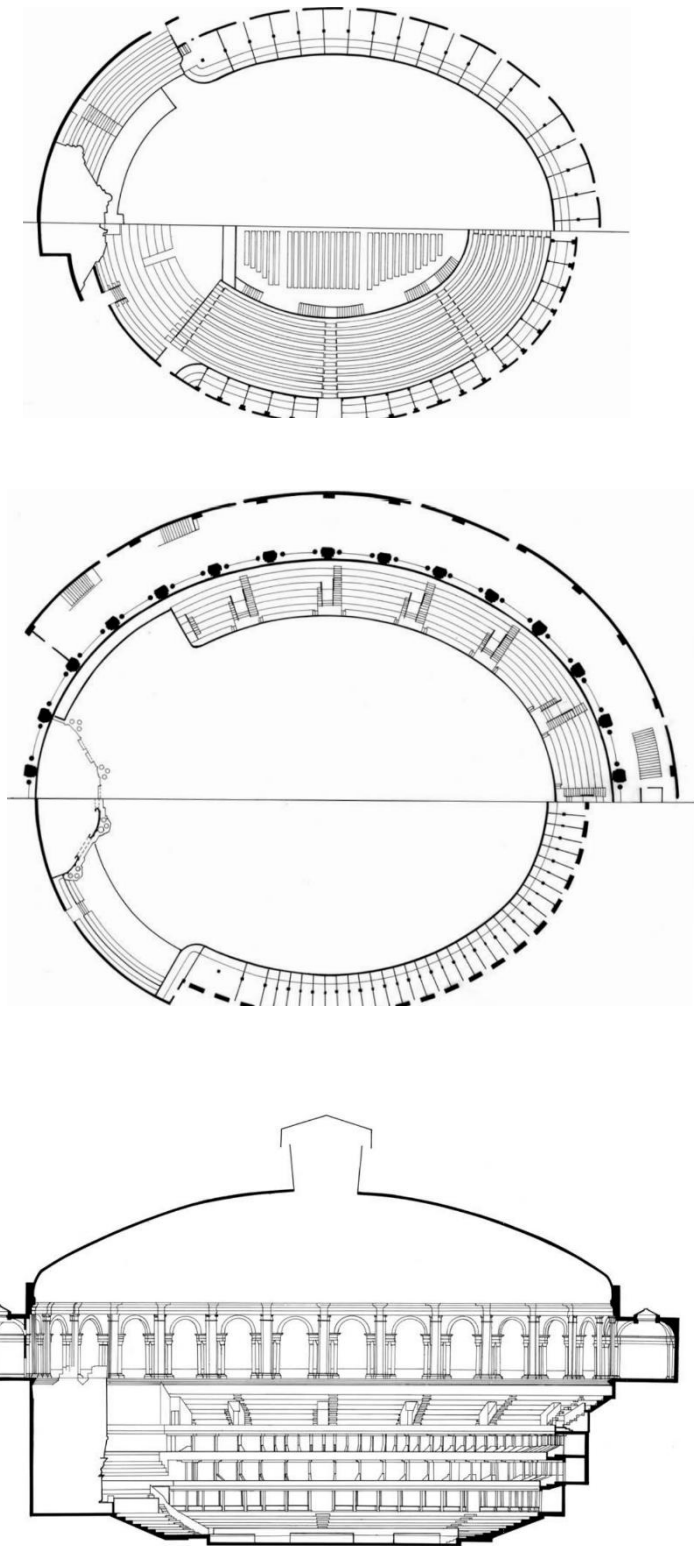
Royal Albert Hall, Londres. Plantas e Corte Longitudinal (Barron, 2009)
